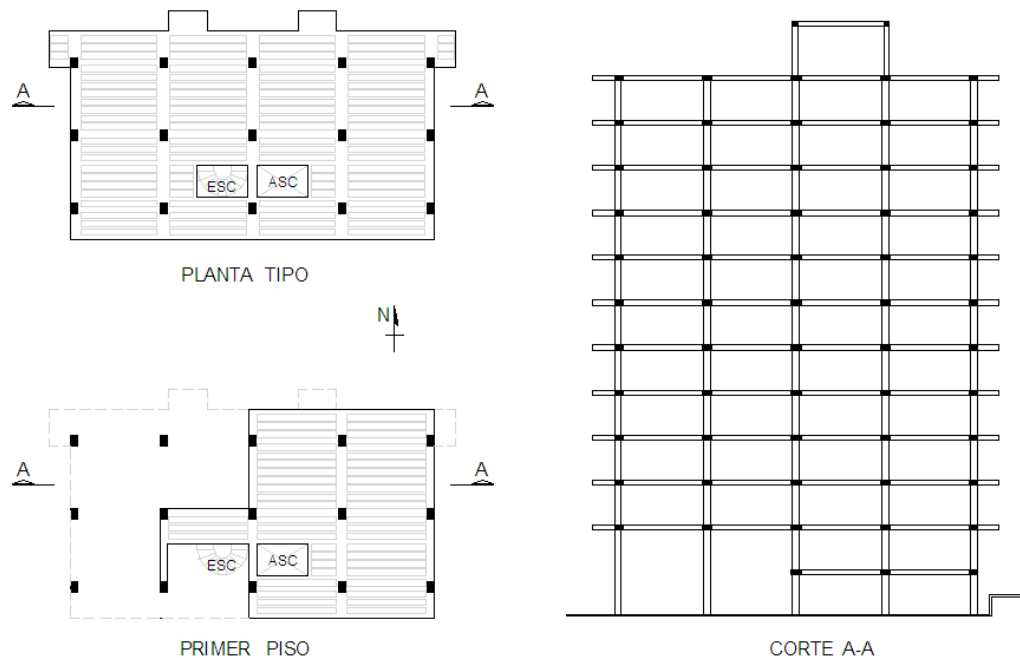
Edificio Mijagual, plantas y corte de la estructura
